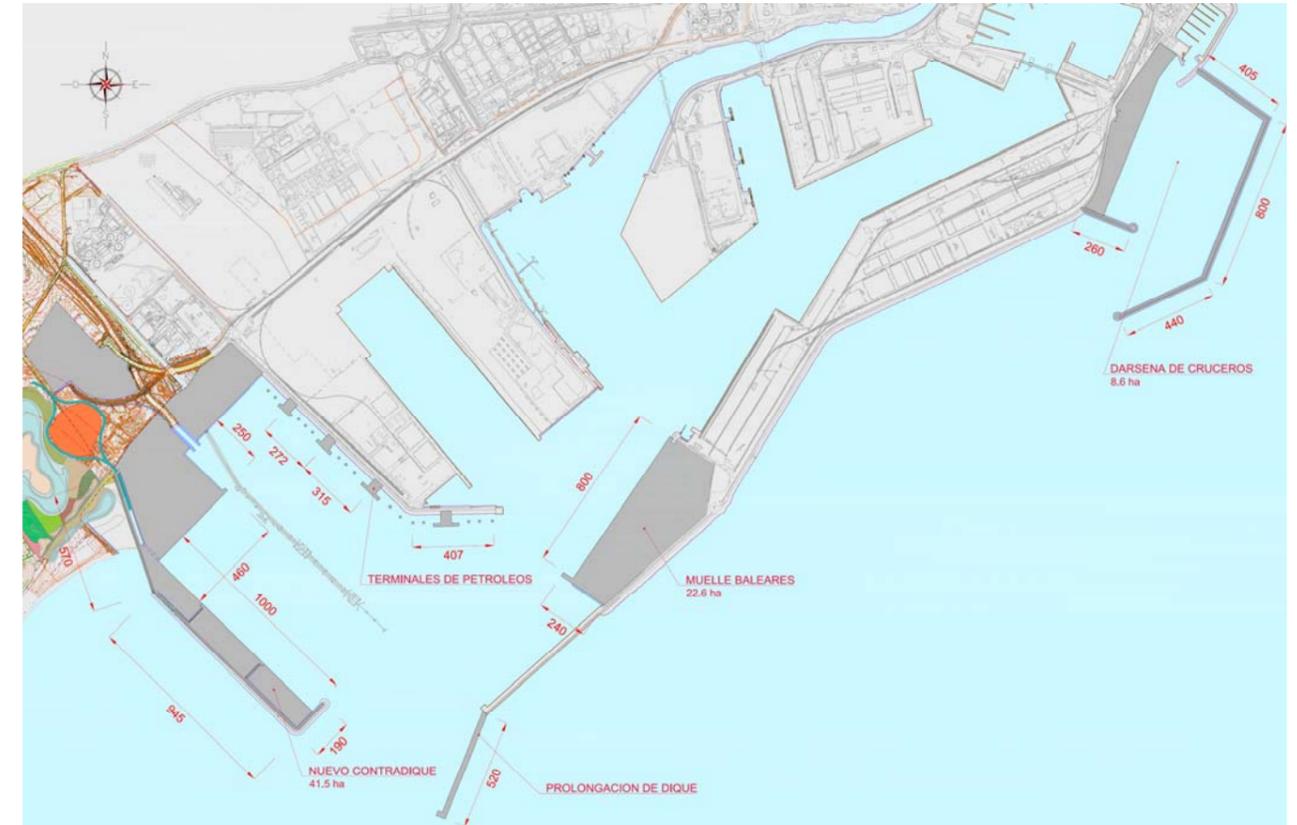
Planta general de las actuaciones que comprende el Plan Director
